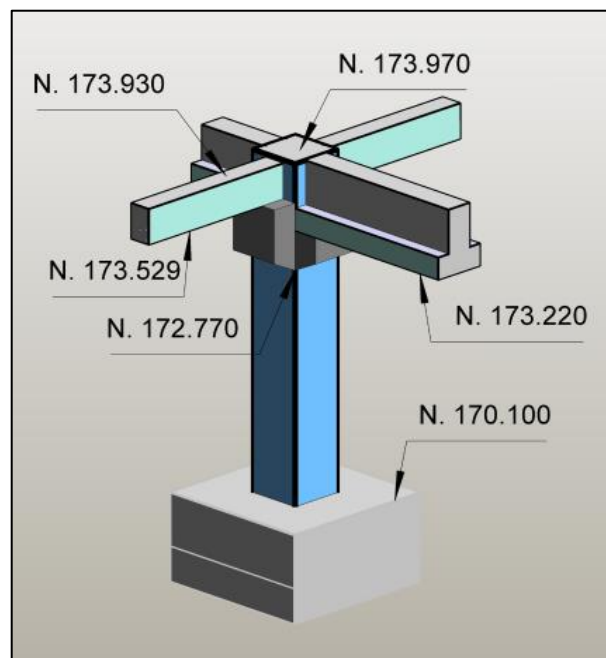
Detalle de columna estructural del Estacionamiento con detalle de niveles para las ménsulas y vigas prefabricadas.
